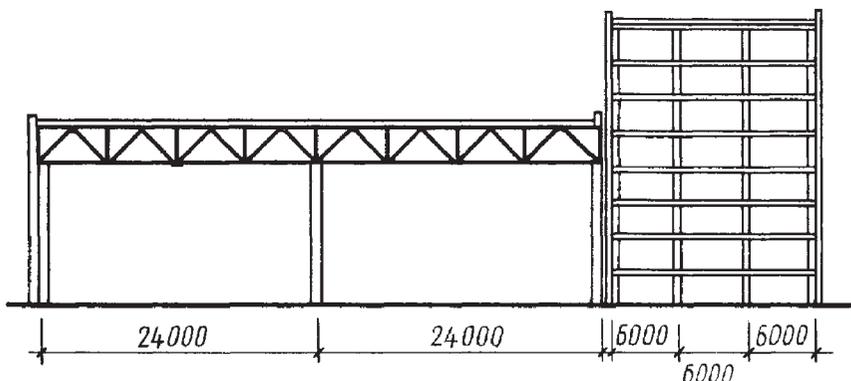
Схема поперечного разреза промышленного здания смешанной этажности
